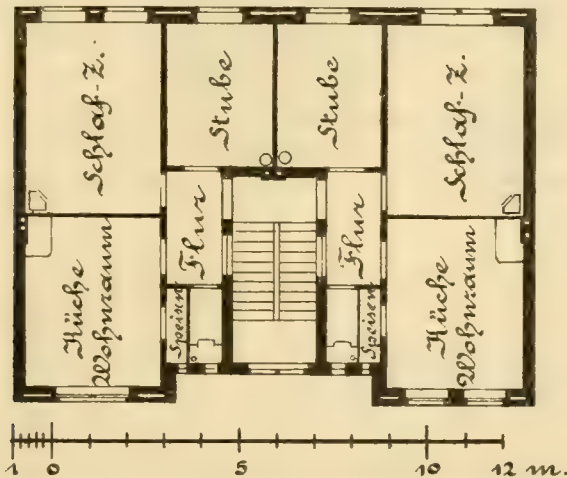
Plan eines Arbeiterwohnhauses. Grundriss der Obergeschosse
